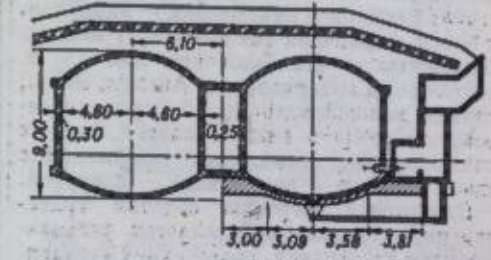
Обделка подземного резервуара для бензина (Франция).
